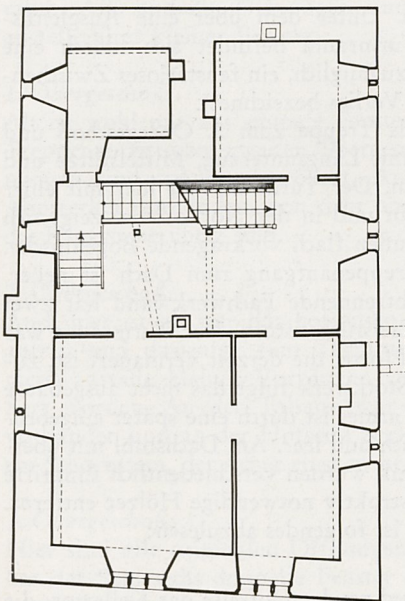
Grundriß vom 2. Obergeschoß M 1:200, Zustand 1971
